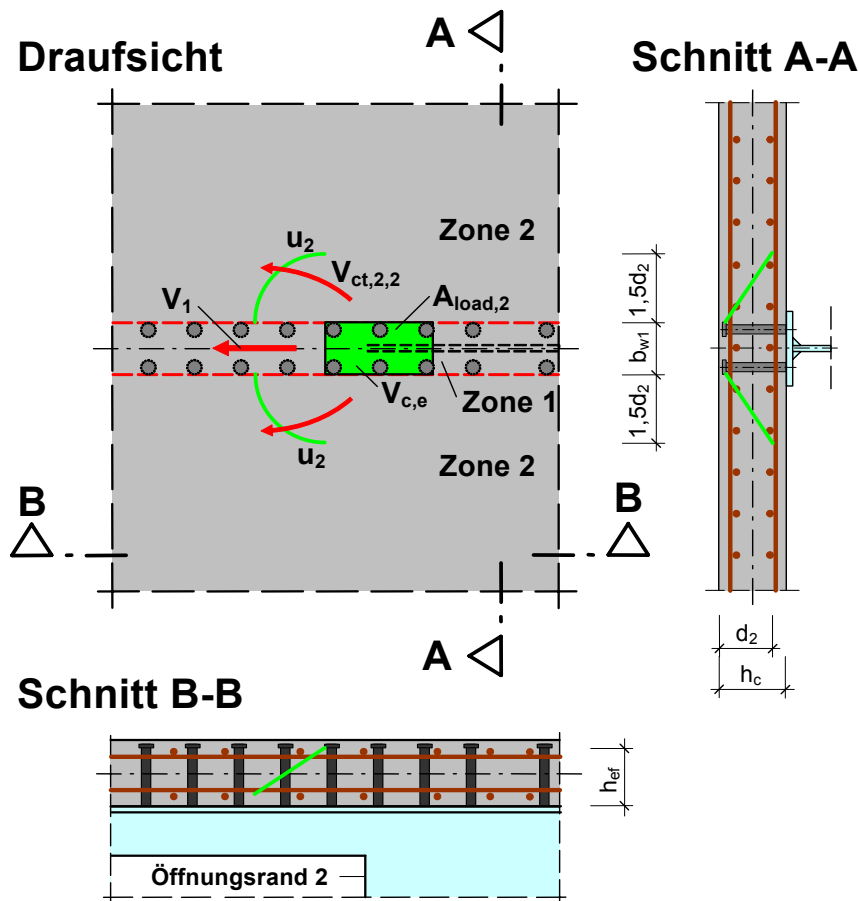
Einleitung der Querkraft in den Betongurt am Öffnungsrand 2
